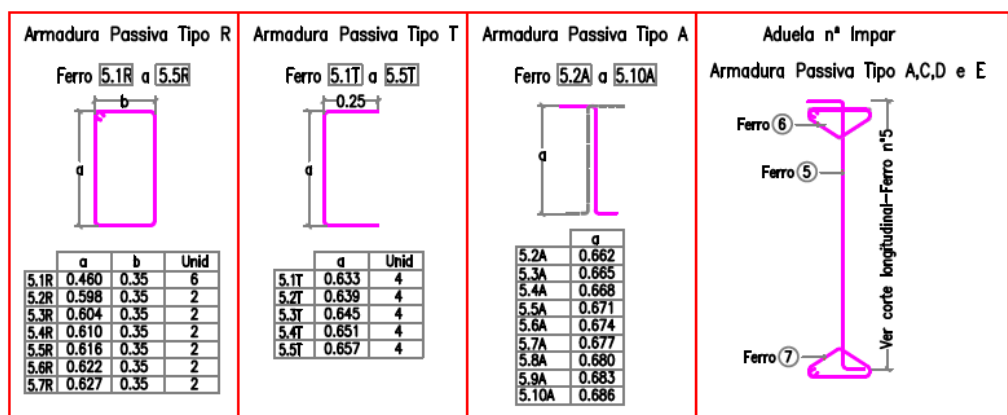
Desenhos técnicos com pormenorização de dimensões de estribos
